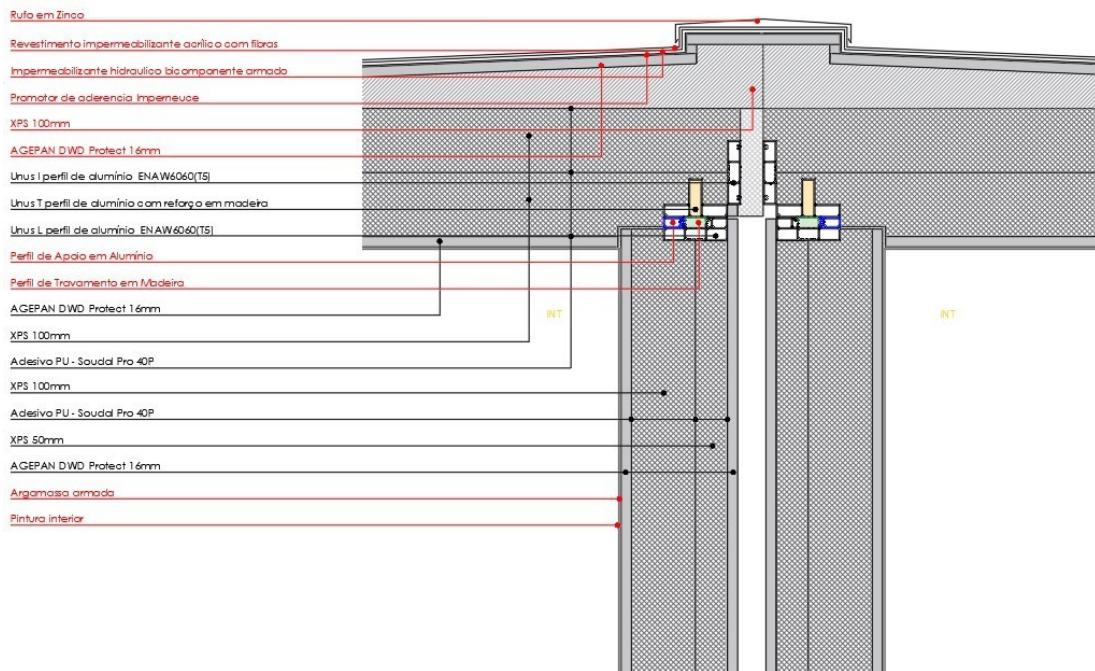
Solução Final – Pormenor construtivo de parede interior/cobertura de duas frações independentes.
